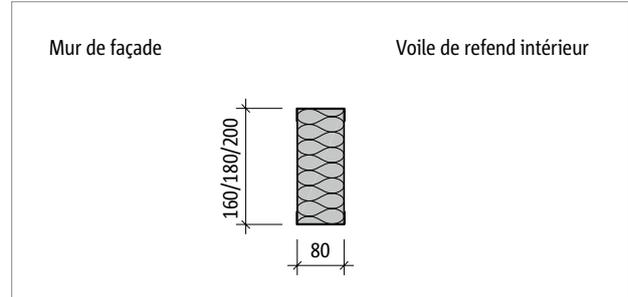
Schöck Rutherma® T type RF-Z : vue en plan
